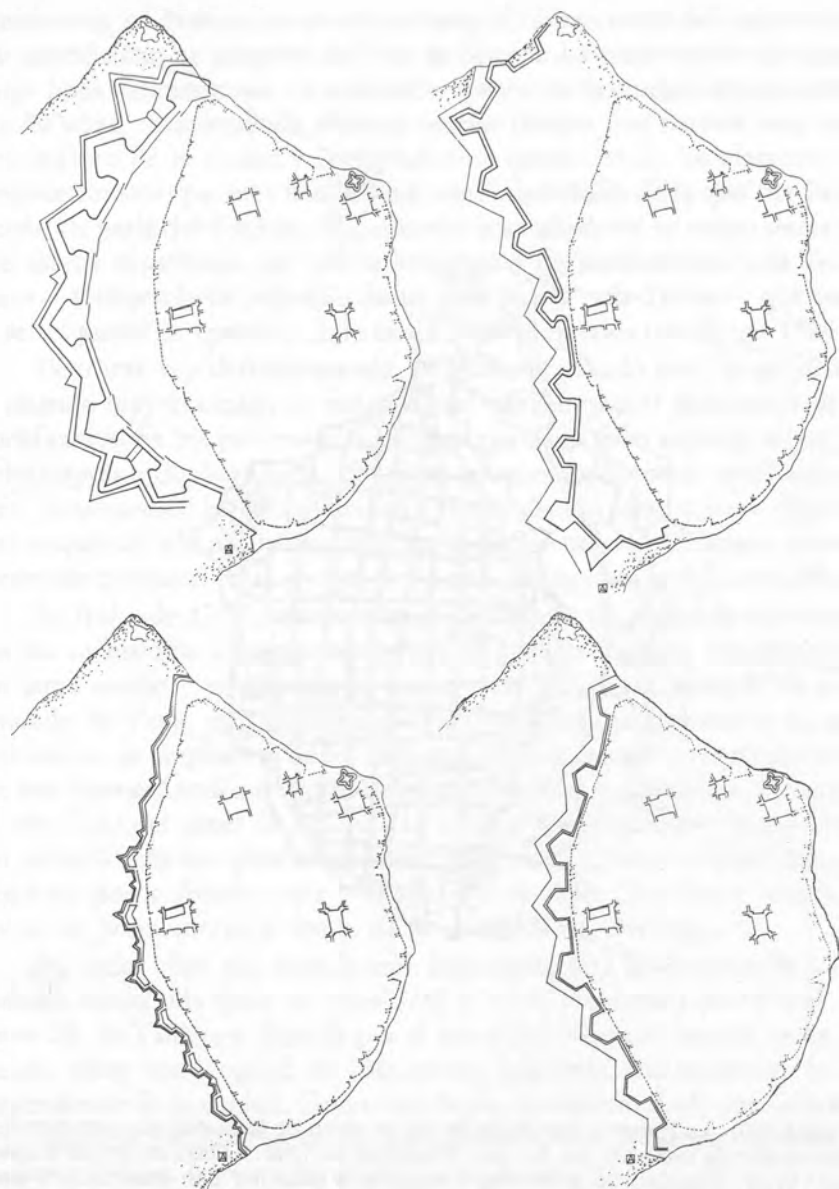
Murallas de La Habana. Sobre un plano esquemático del recinto intramuros de La Habana, cuatro proyectos de murallas. Antonio Arredondo, 1746; Bruno Caballero, 1729; Antonio Arredondo, 1740; Juan de Sísara, 1677.
